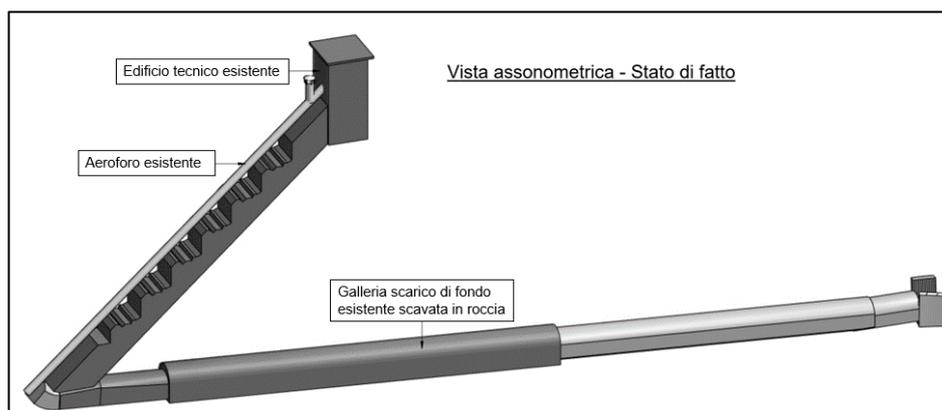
Scarico di fondo – Vista assonometrica (stato attuale)
